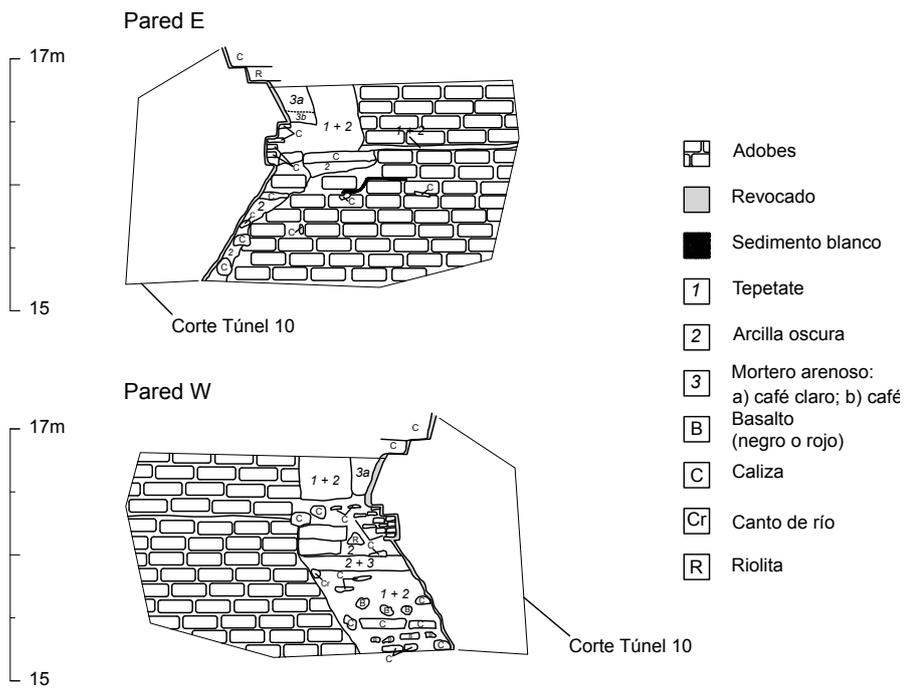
Perfiles del túnel 51; se muestra el sistema constructivo de los tableros.
